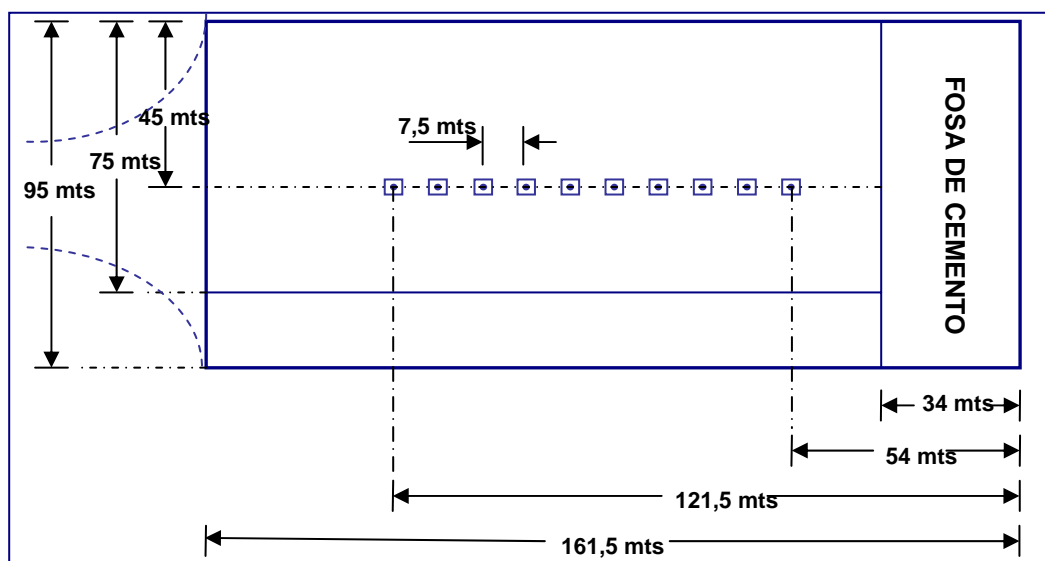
Vista en planta de la Macolla tradicional del Distrito Cabrutica.^[4]
